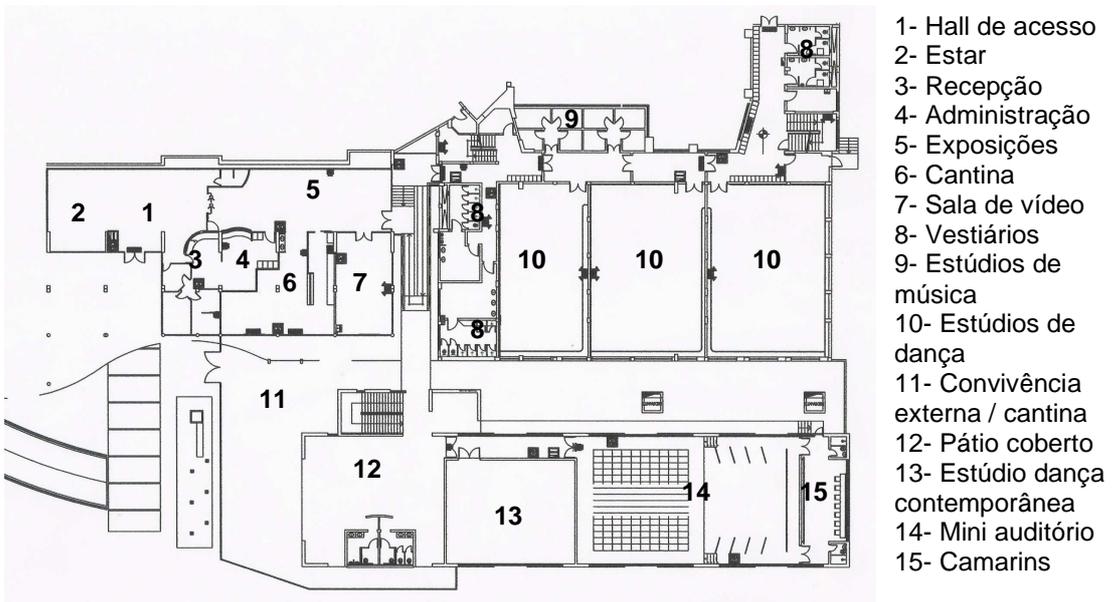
Planta Centreventos – (Fonte: ETBB,2007)
